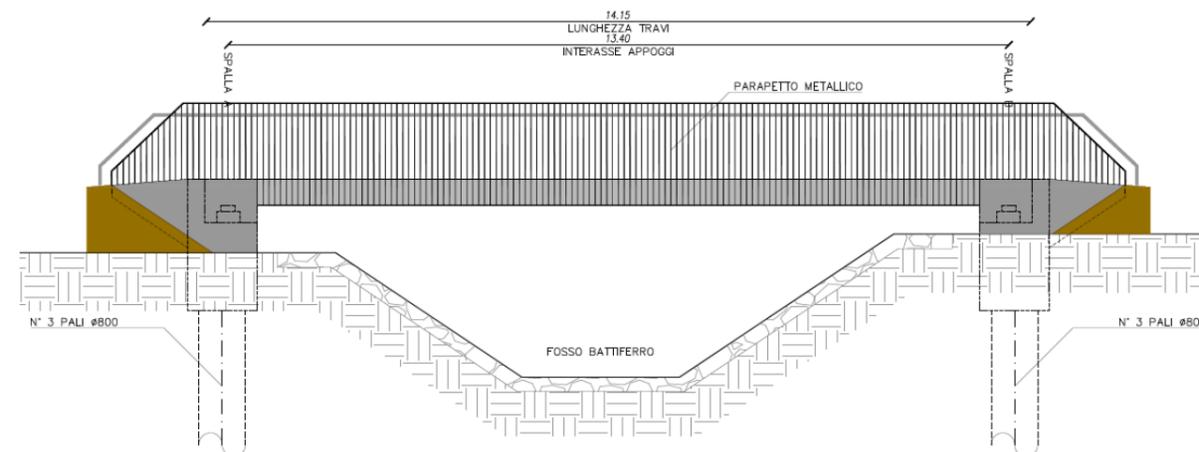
Prospetto passerella sul Battiferro²⁸
